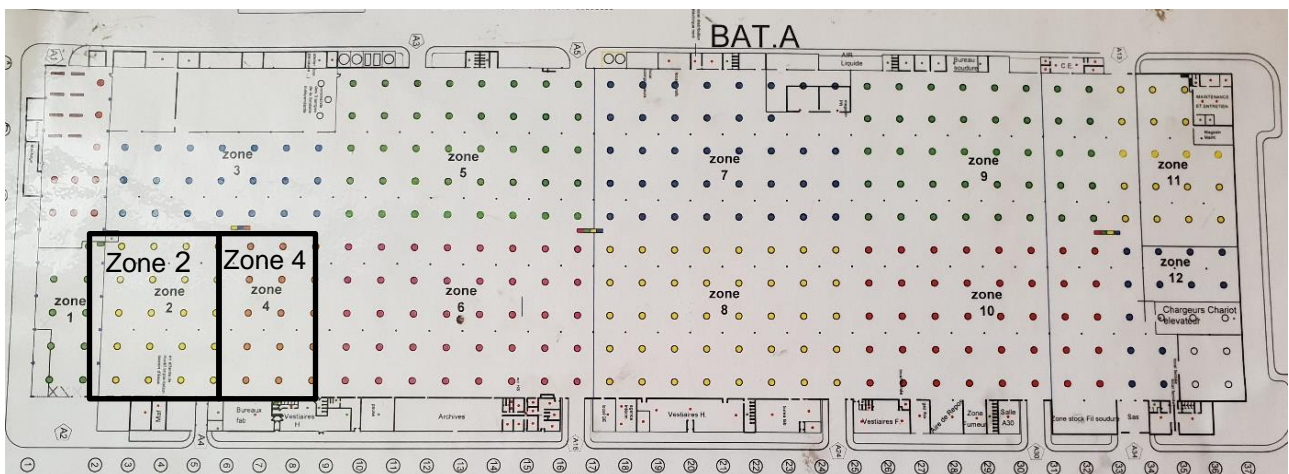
Plan d'implantation des luminaires dans le bâtiment A
